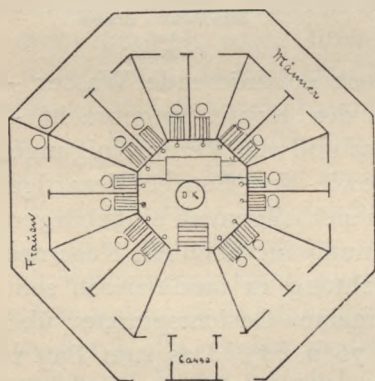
Grundriss eines Volksbrausebades.
